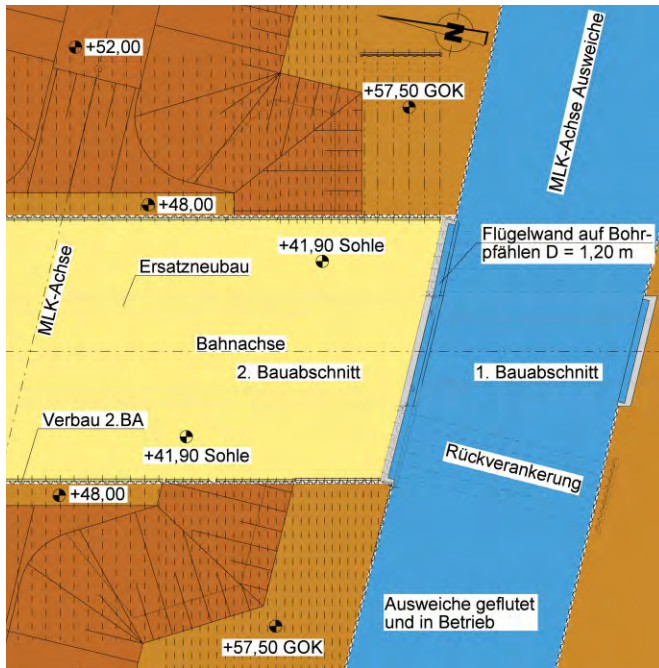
Draufsicht Übergang Baugrube 1. BA zum 2. BA
